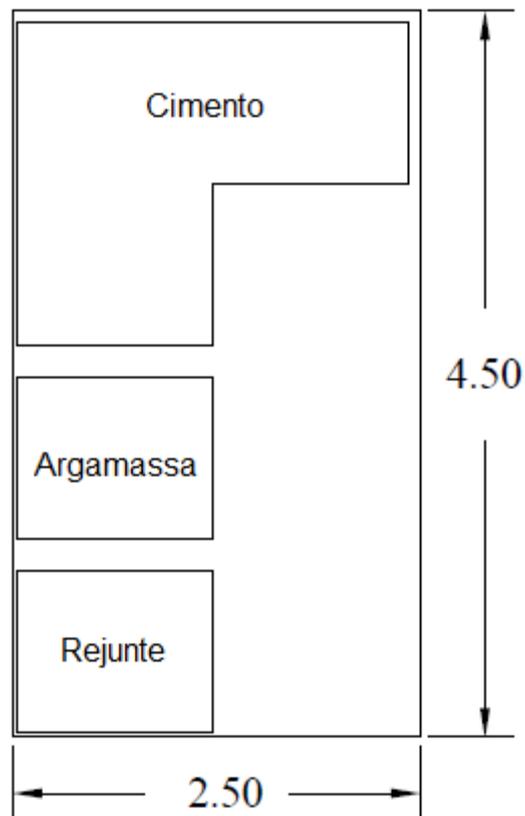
Vista Superior do contêiner de cimento, argamassa e rejunte.
